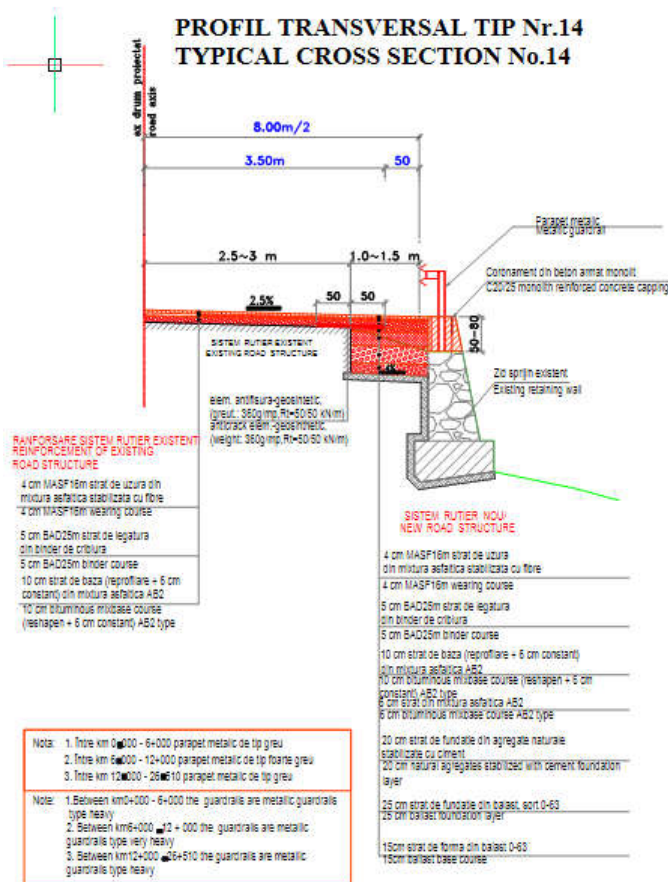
Profil transversal tip nr.14 – Coronament din beton armat la zid de sprijin existent
